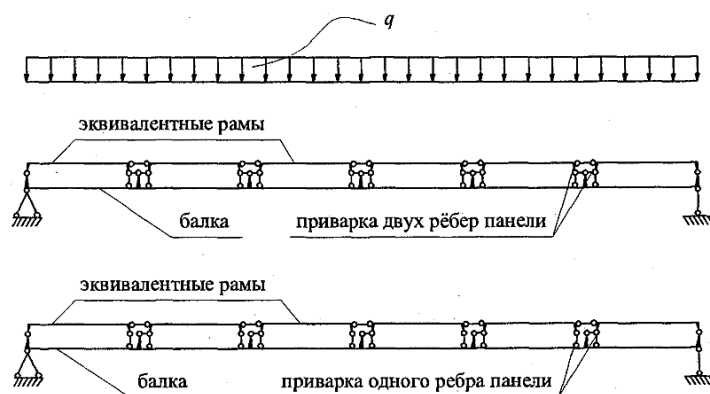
Расчетная схема стропильной конструкции с эквивалентными рамами
